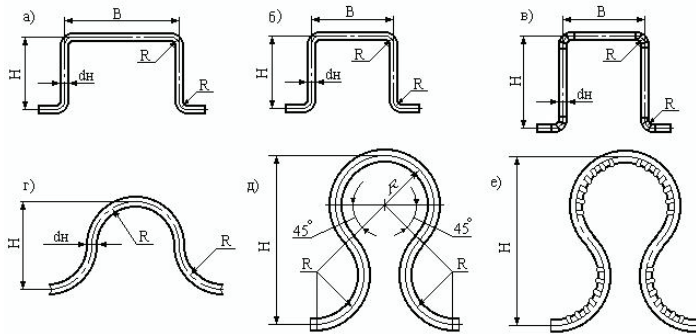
\* Типы гибких компенсаторов: *a* – П-образный с большой спинкой; *б* – то же, равносторонний ( $B = H$ ); *в* – П-образный со сварными коленами; *г* – омегаобразный; *д* – лирообразный гладкозагнутый; *е* – лирообразный со складками
